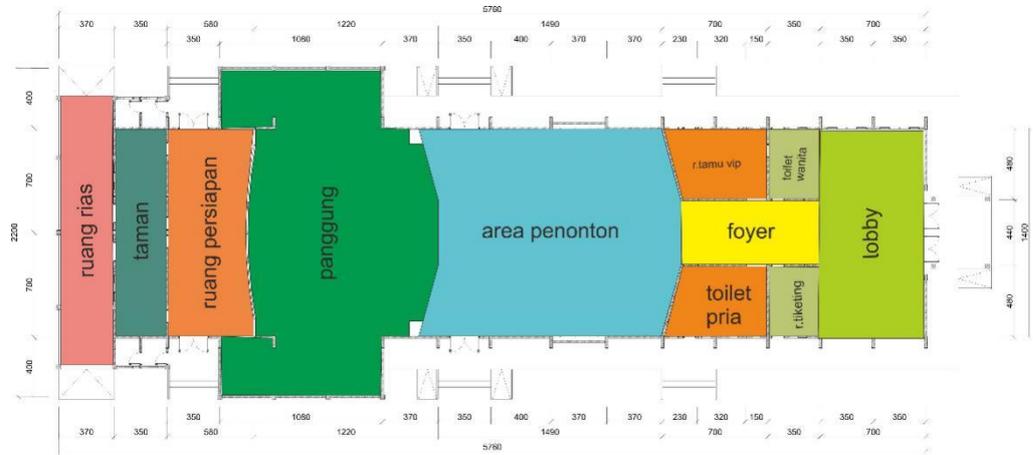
zoning dan sirkulasi lantai 1 alternatif 1
